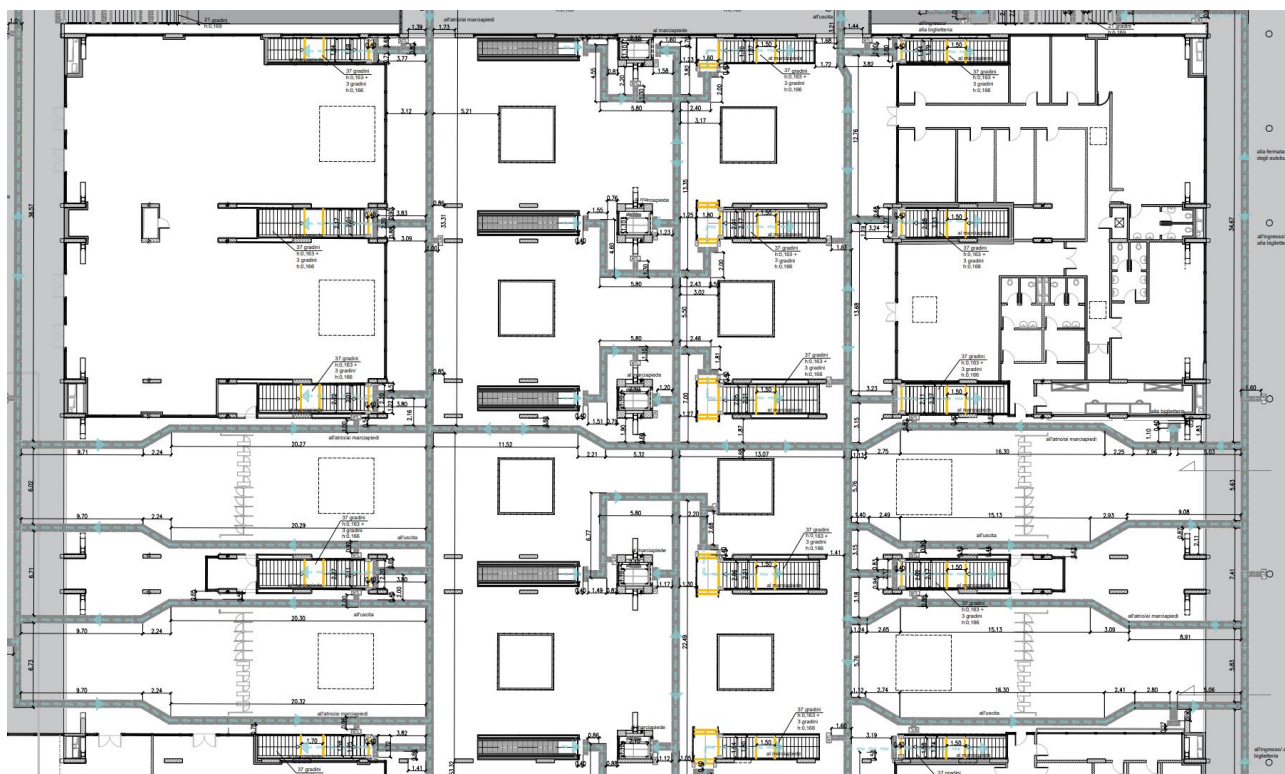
Stralcio Planimetria percorsi tattili Piano Ingressi esistente.
